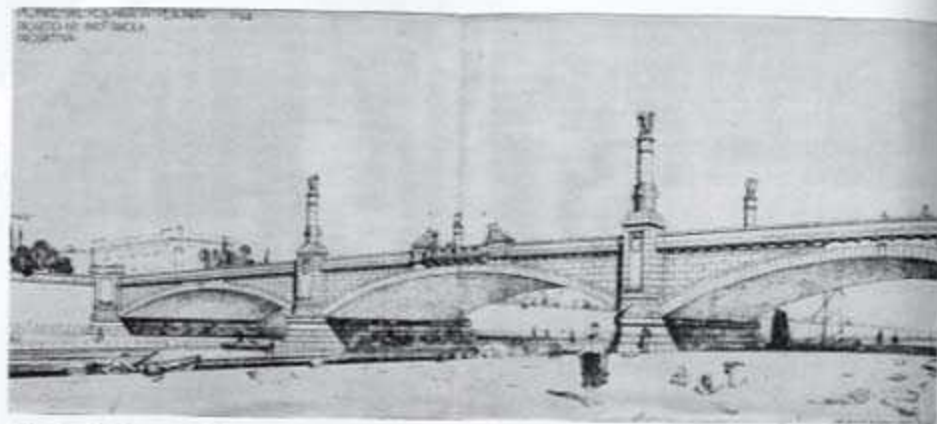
C. Bazzani. Pescara. Ponte Littorio. Prospettiva di progetto (Archivio di Stato, Terni [ASTn], Fondo Bazzani).
